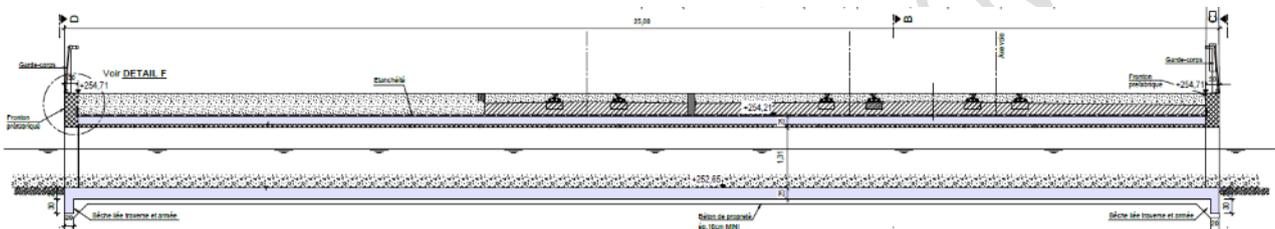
Coupe longitudinale de l'OA Lertzbach au droit du Sud de la rue du Ballon (Source : Tertio, 2017)
